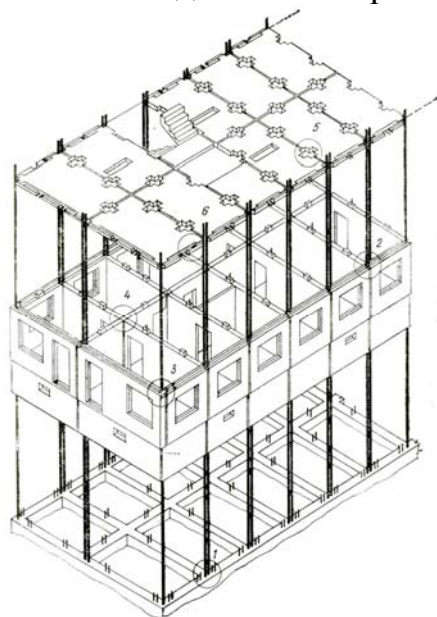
Принципиальная конструктивная схема крупнопанельного здания с арматурой и шпоночным соединением элементов
